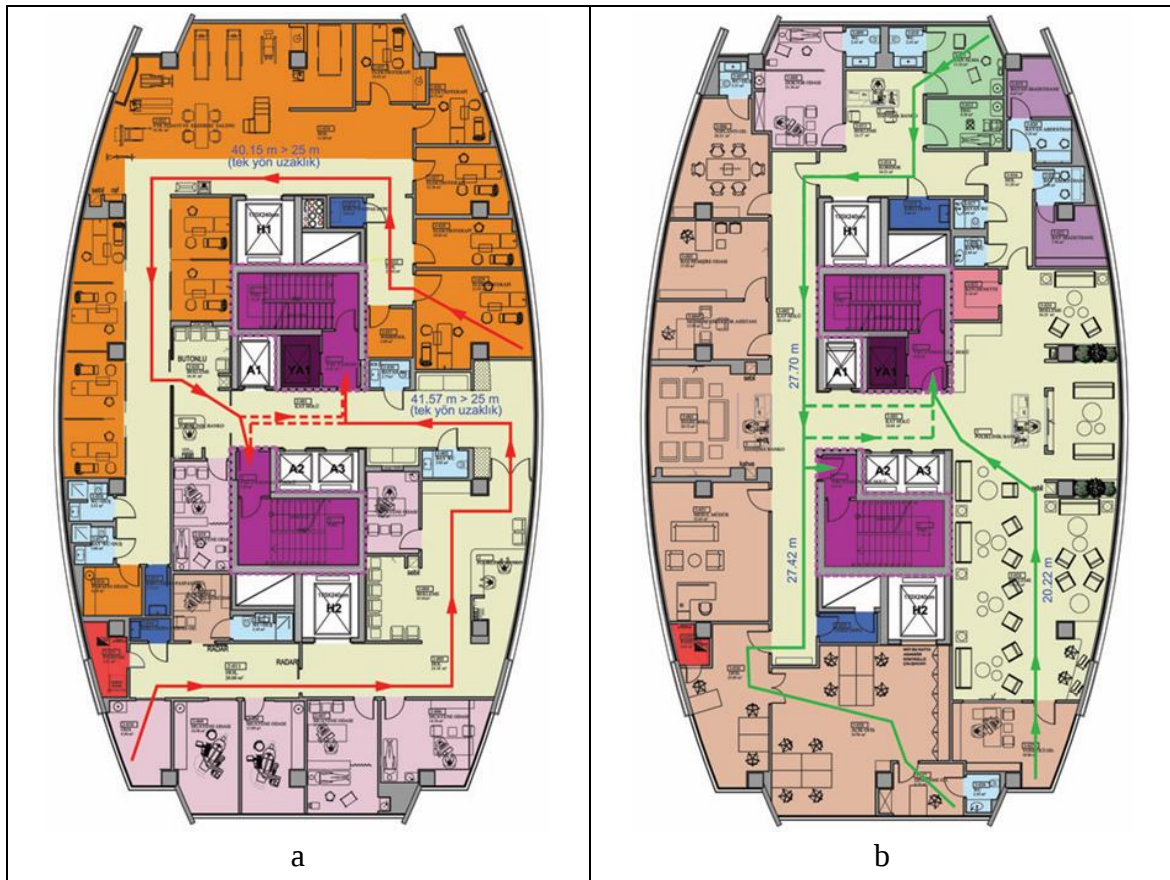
a. 1. Kat planı, b. 2. Kat planı
